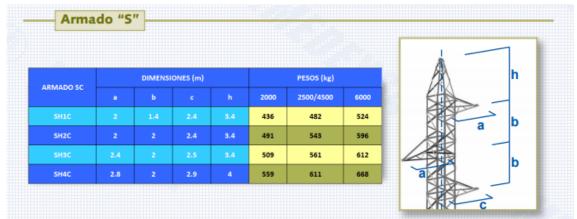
Detalla constructivo apoyo de celosía con armado tipo "S"
